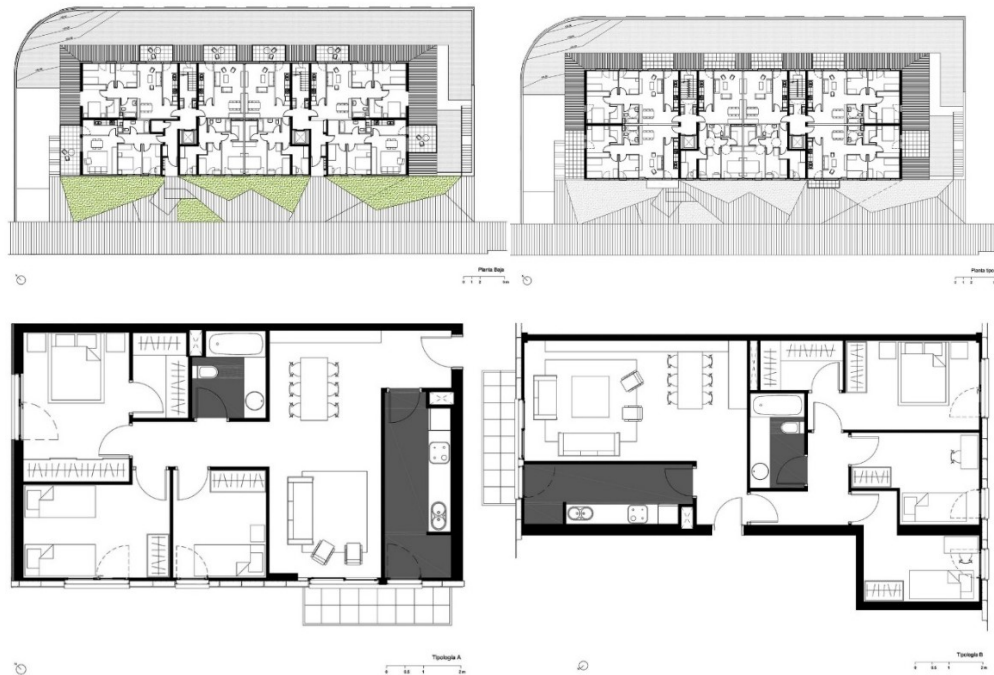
Bangunan Social Dwelling di Spanyol
